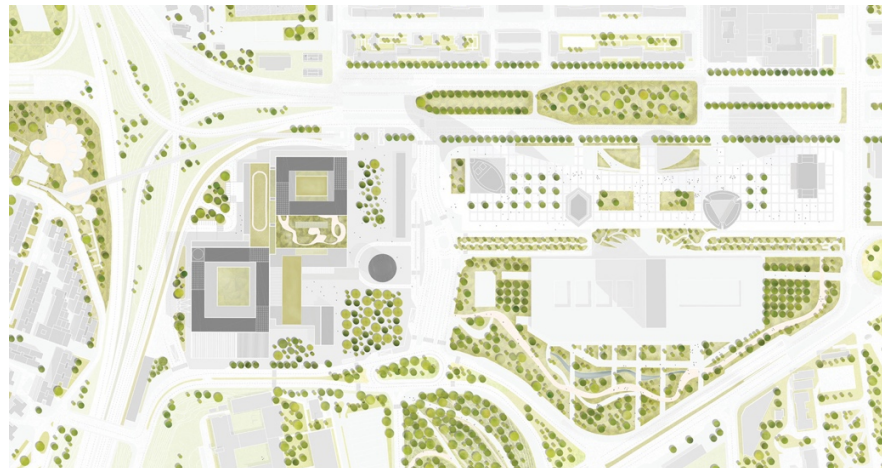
Planta de localización. Proyecto de ampliación Hospital de la Paz, Madrid. Fuente: Archdaily, 2021.
